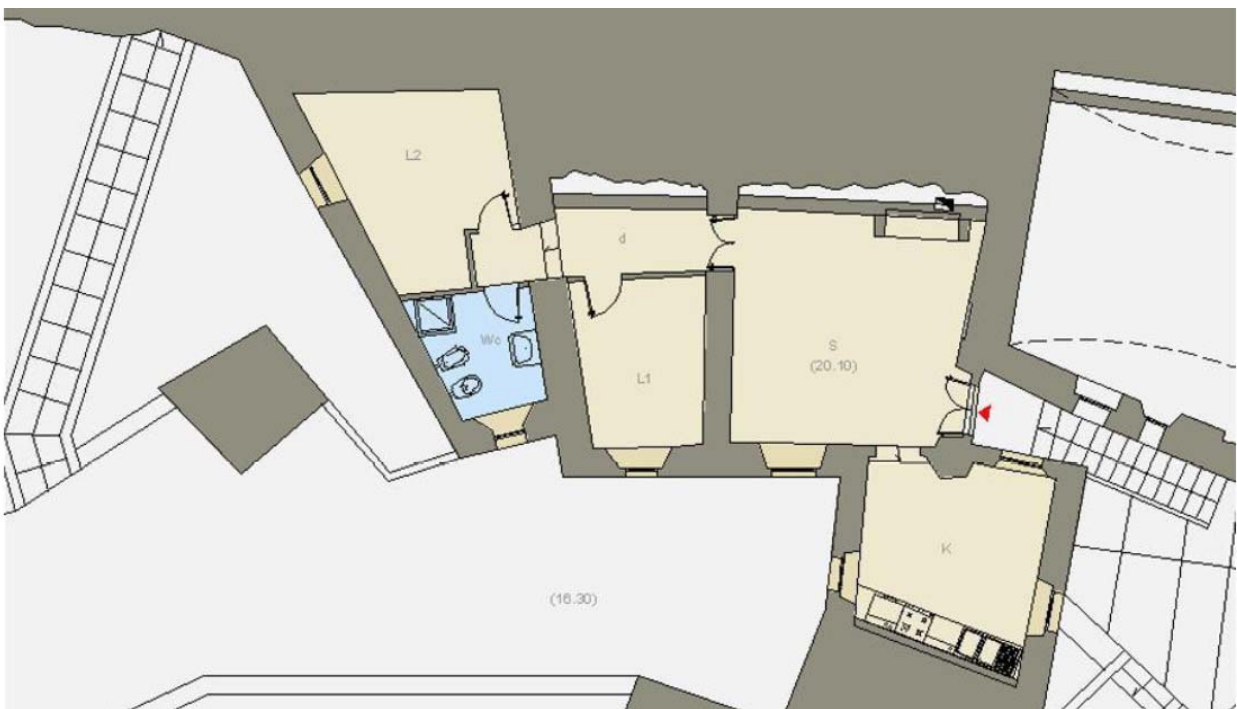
Planimetria generale degli interventi. Appartamento tipo su un livello
